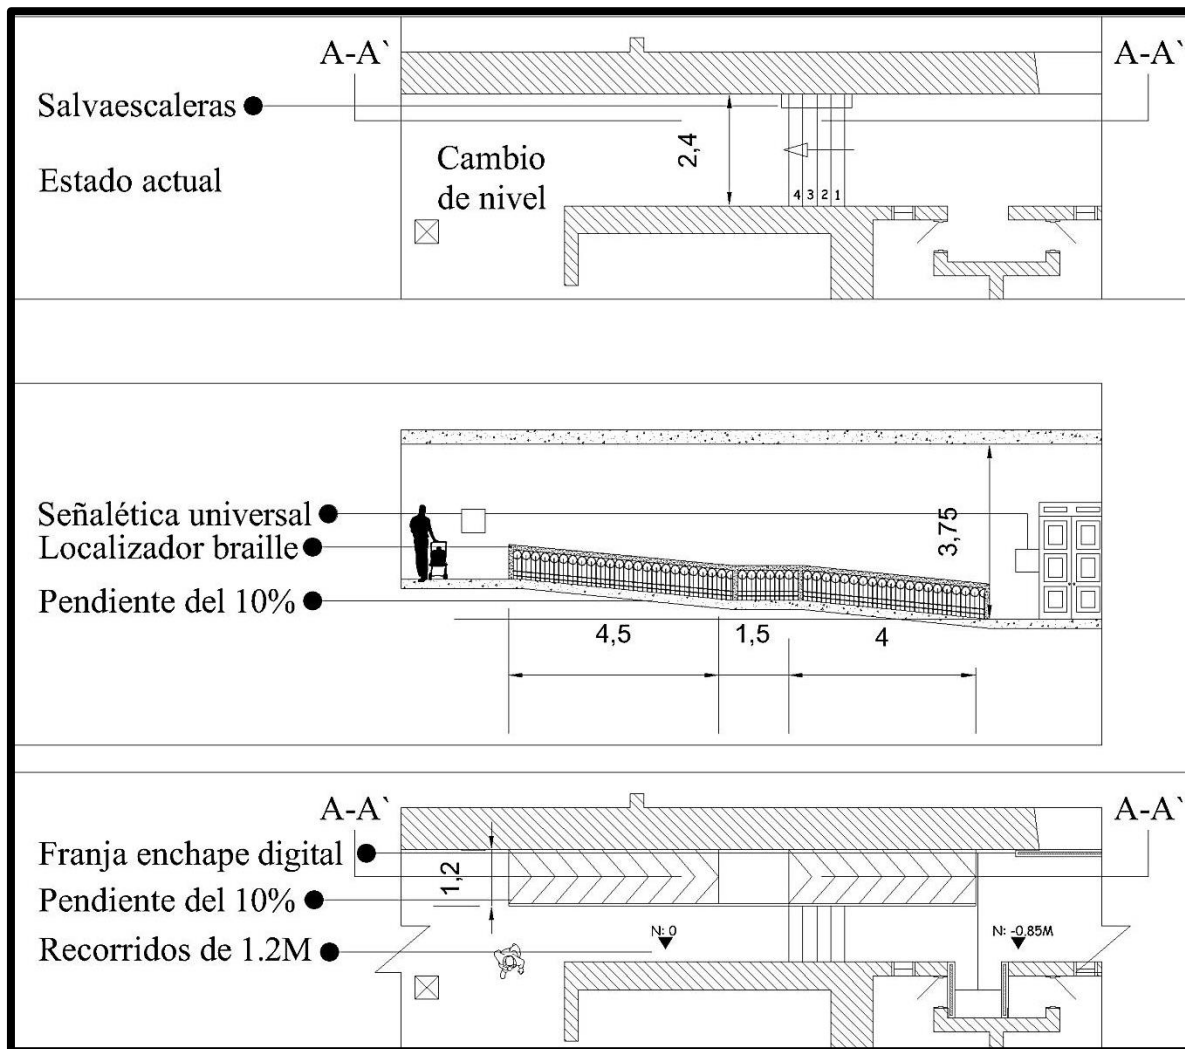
Propuesta arquitectónica en zona 2 para adaptación de rampa (Fuente: elaboración propia, 2018)
